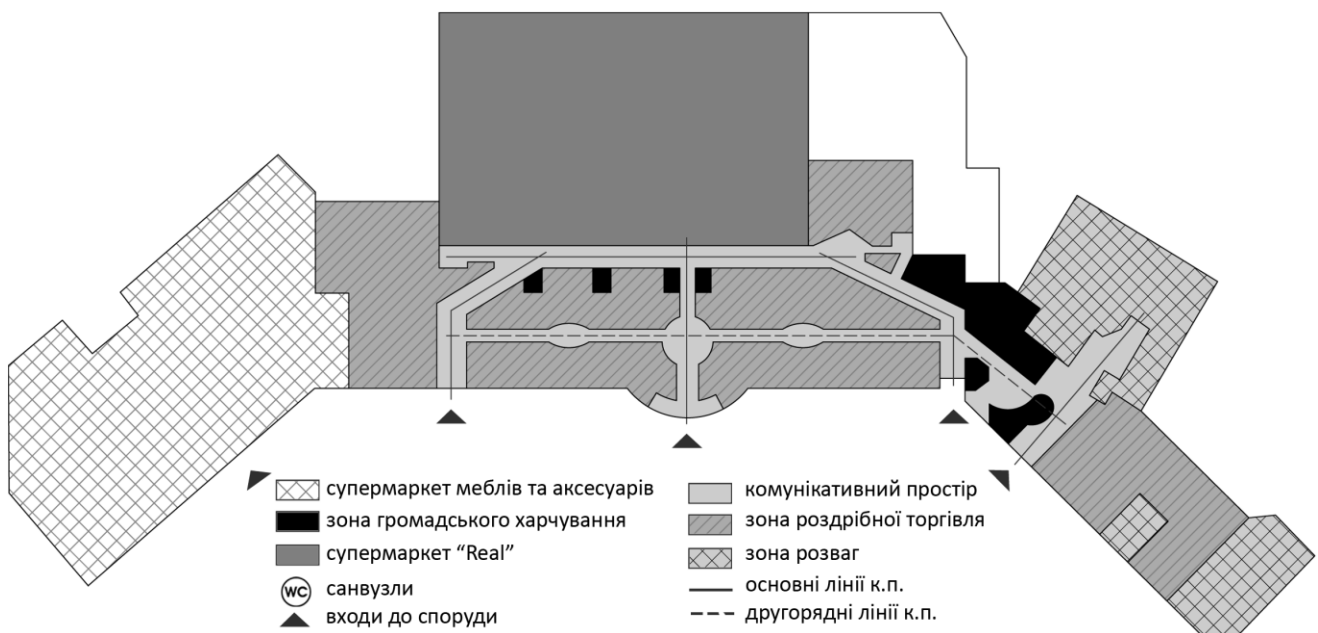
Схема планування молу «Janki» (на основі схеми з [7]).
